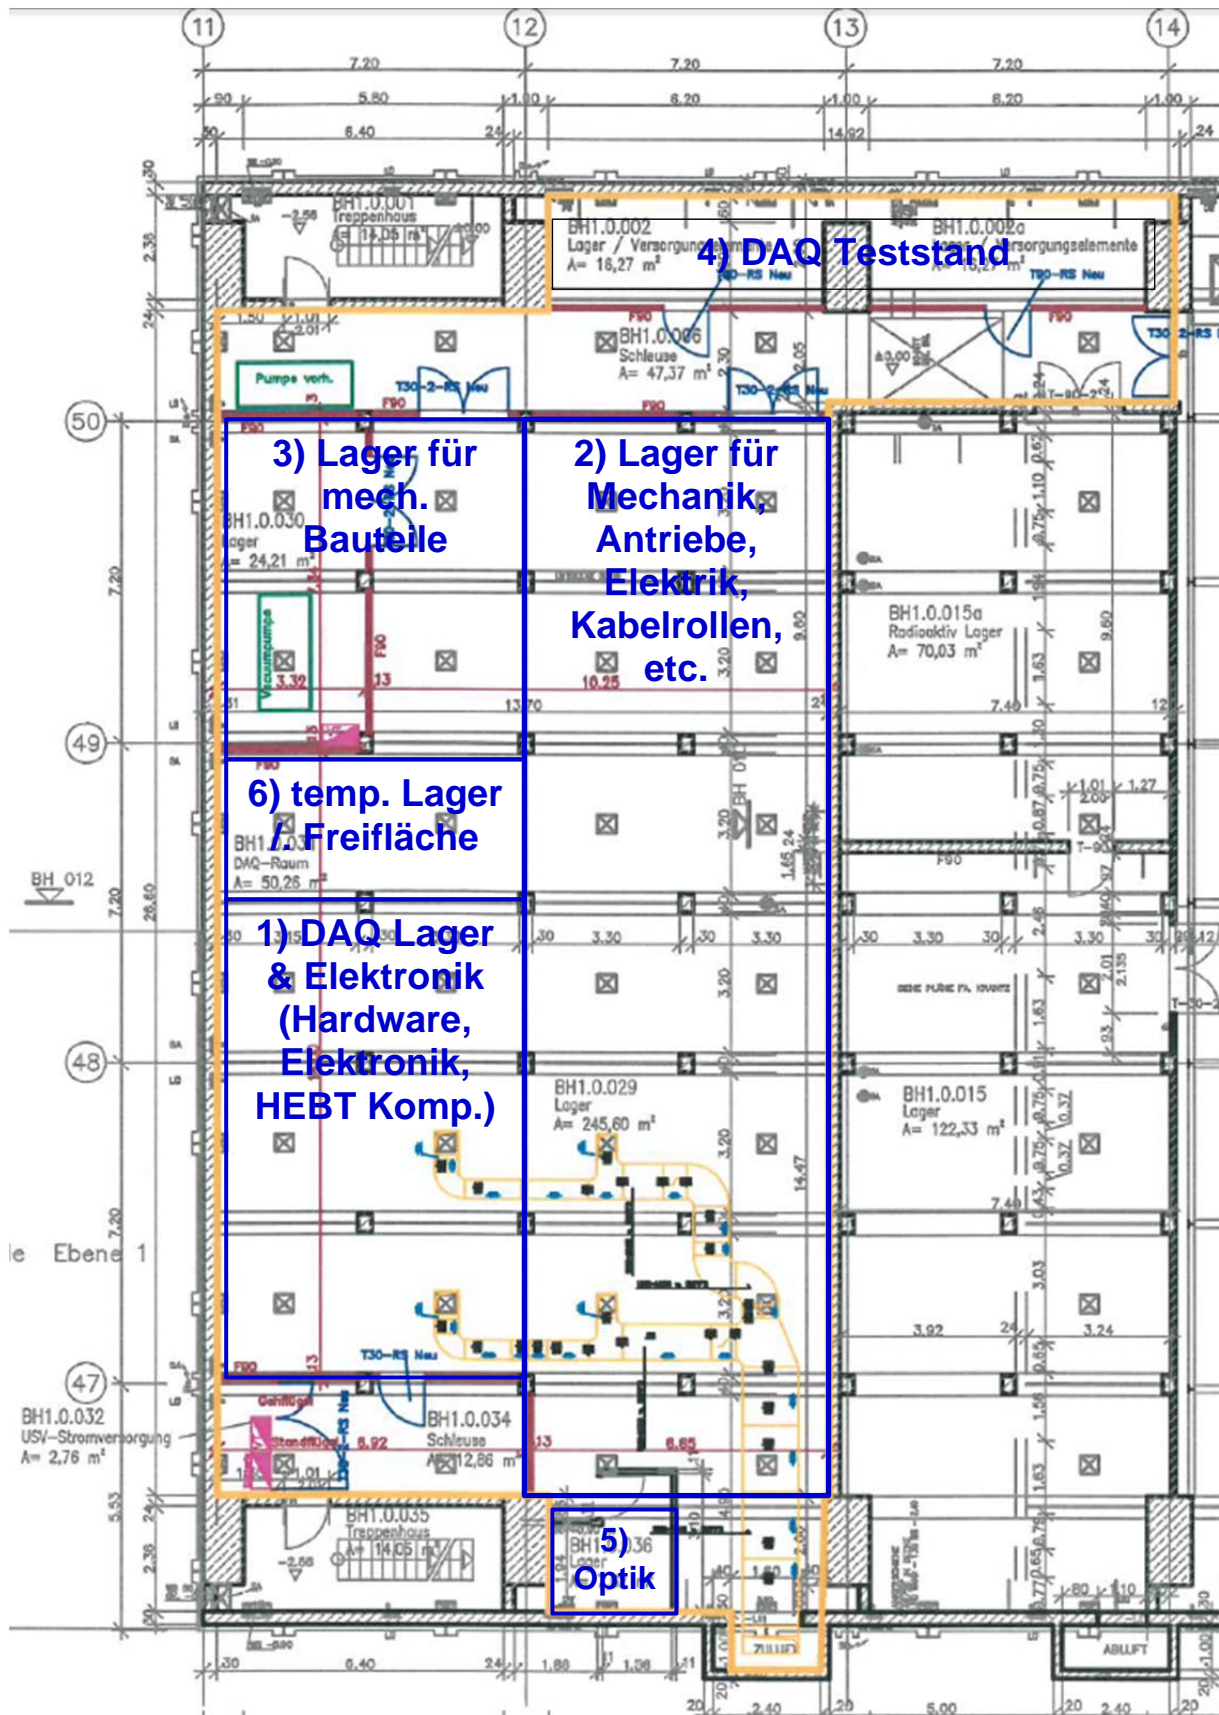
Grundriss (Ausschnitt) der Kellerebene in der Betriebshalle BH1. Die Flächen der Baumaßnahme sind in oranger Farbe markiert.
